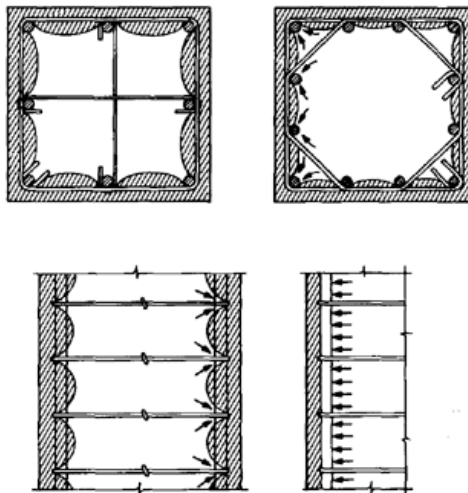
Confinamento trasversale e longitudinale offerto dalle staffe (Paulay e Priestley, 1992).
